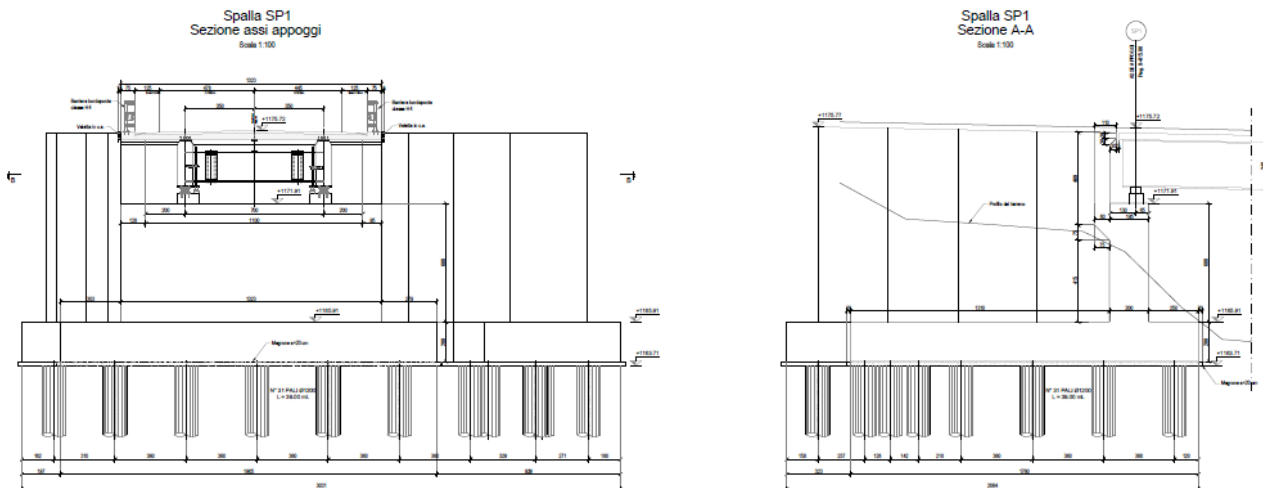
Ponte Rio - Carpenteria spalla 1
